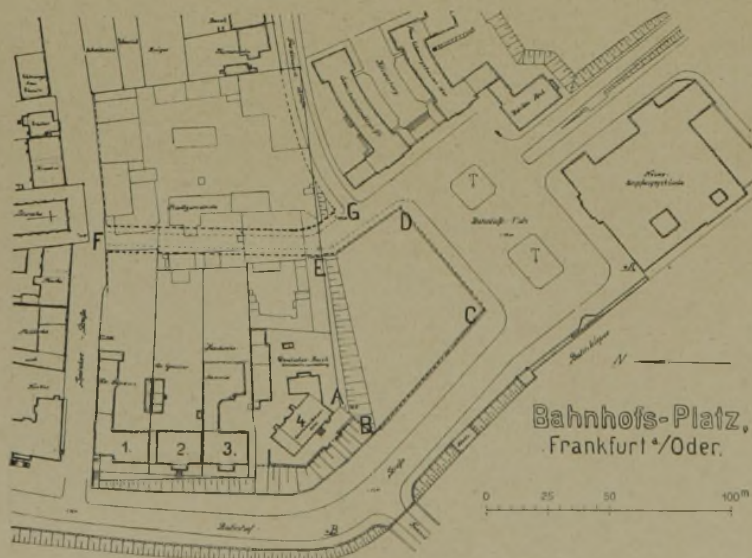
Lageplan des Bahnhofsvorplatzes.
